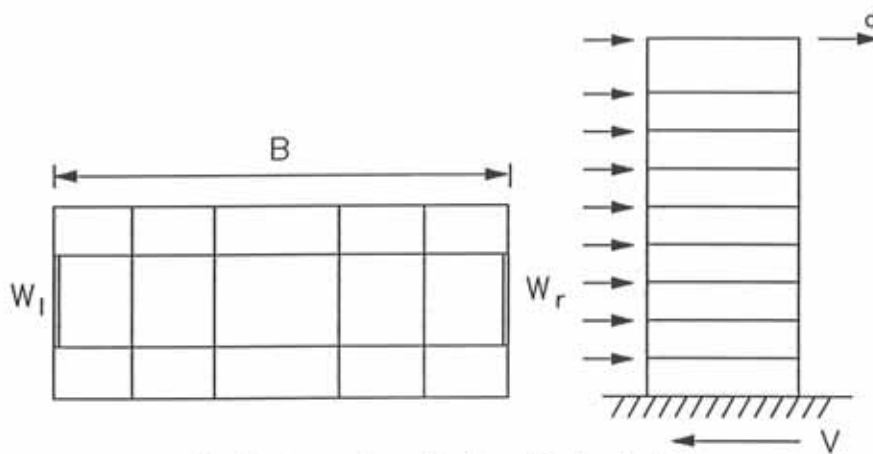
Edificio de 17 pisos que falló por asimetría en planta.
